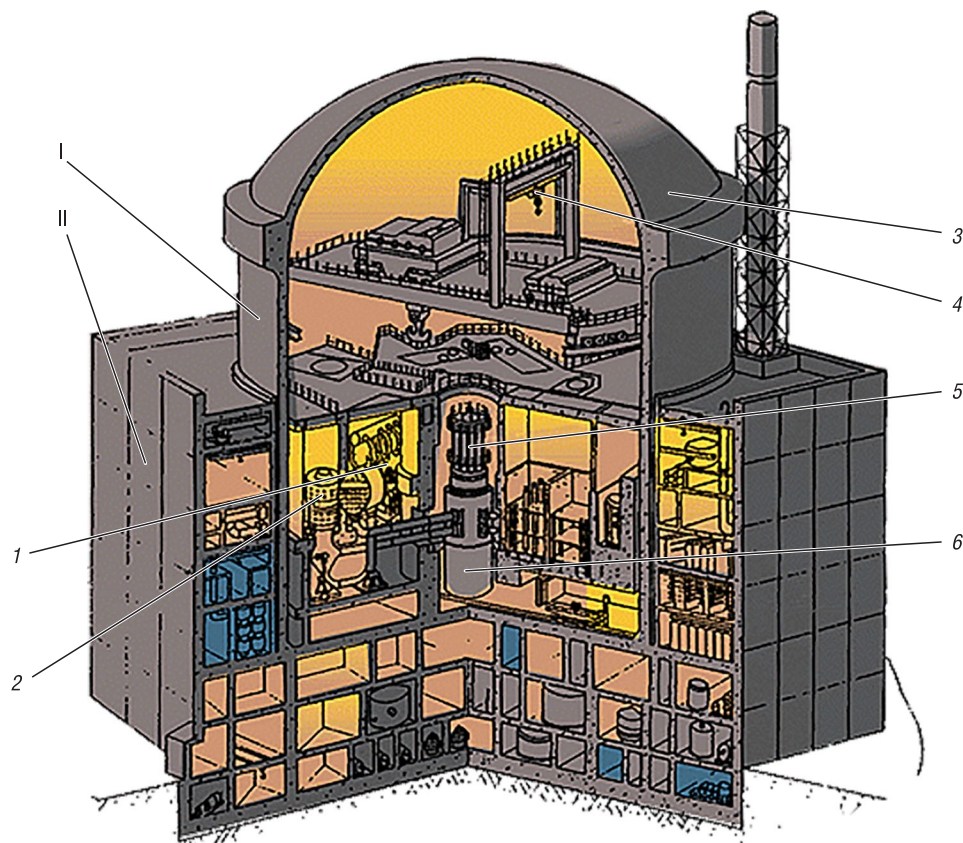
Здание реактора Балаковской АЭС с РУ ВВЭР-1000: I – защитная оболочка, II – обстройка реакторного отделения; 1 – парогенератор, 2 – главный циркуляционный насос (ГЦН), 3 – купол защитной оболочки, 4 – полярный кран, 5 – система управления и защиты (СУЗ) реактора, 6 – реактор
